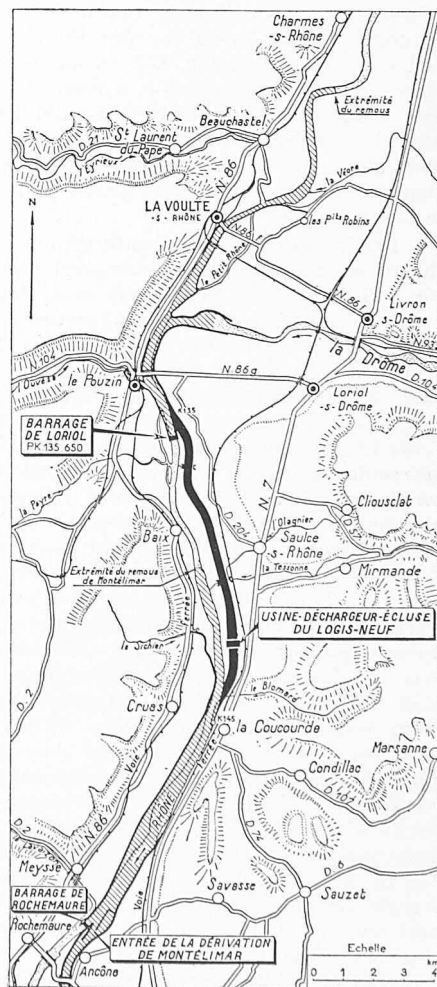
Lageplan 1:250 000 des Ausbaues der Stufe Baix — Le Logis Neuf
